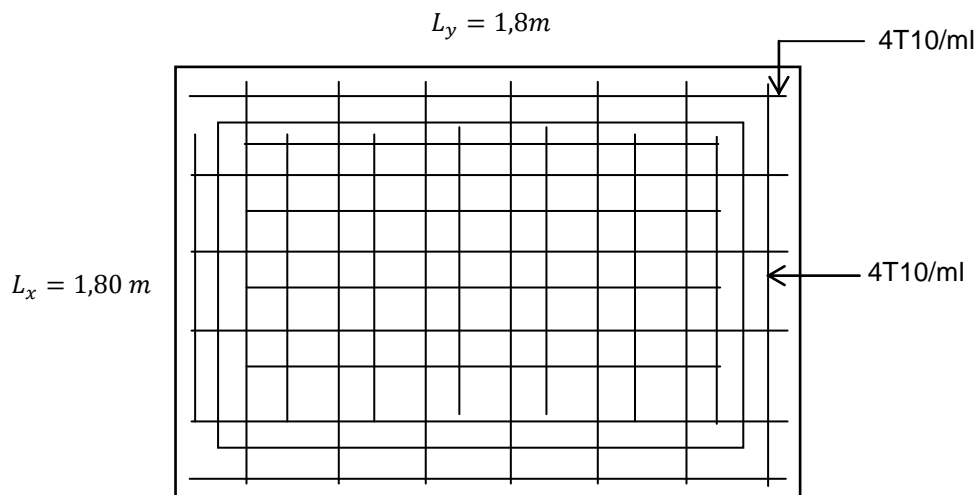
Ferrailage inférieur de la dalle de l'ascenseur
